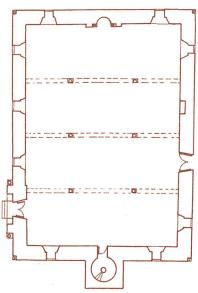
المسقط الأفقى لمسجد الوكيل بسمخراط مقياس رسم ١٠٠٠
